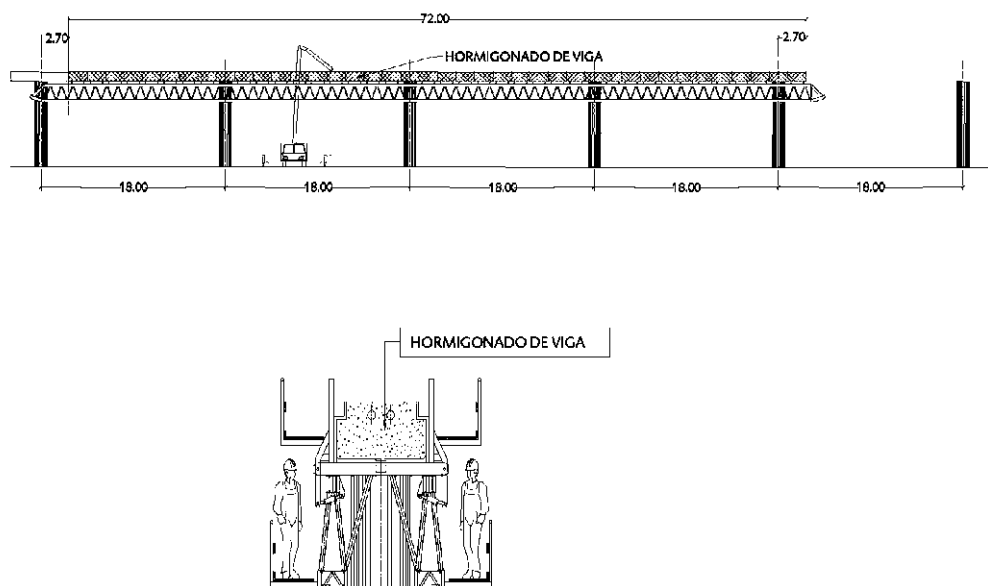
Proceso constructivo, hormigonado de la viga del pórtico con una sección transversal compatible con el postesado y la construcción posterior de los forjados.
